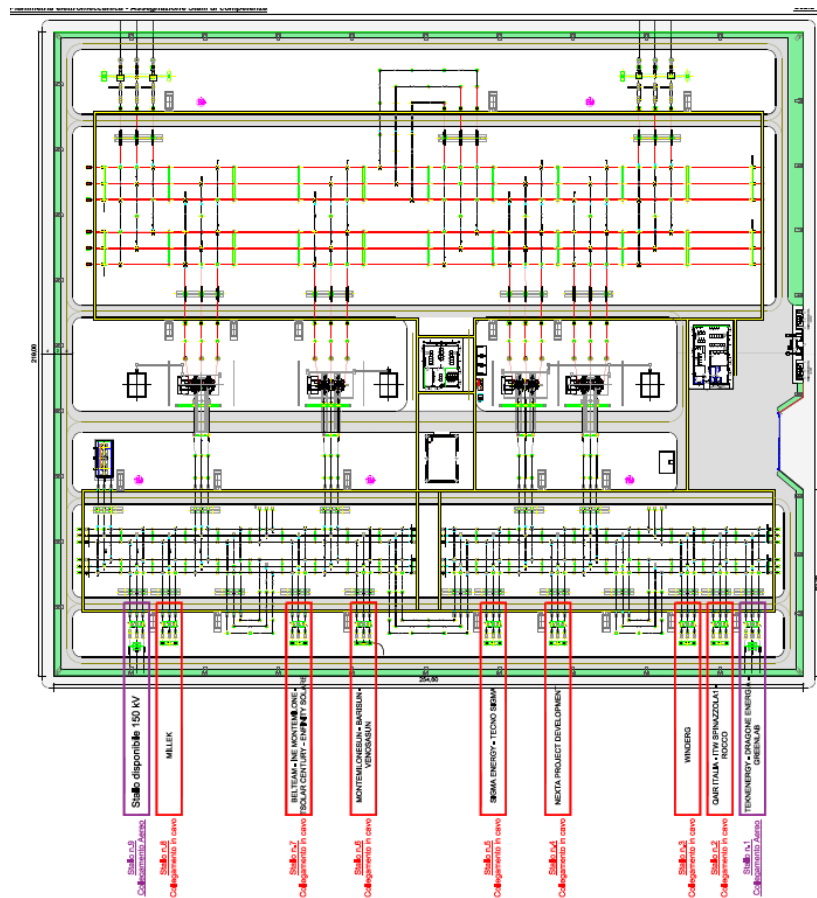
Planimetria SE con ubicazione dell'assegnazione degli stalli
